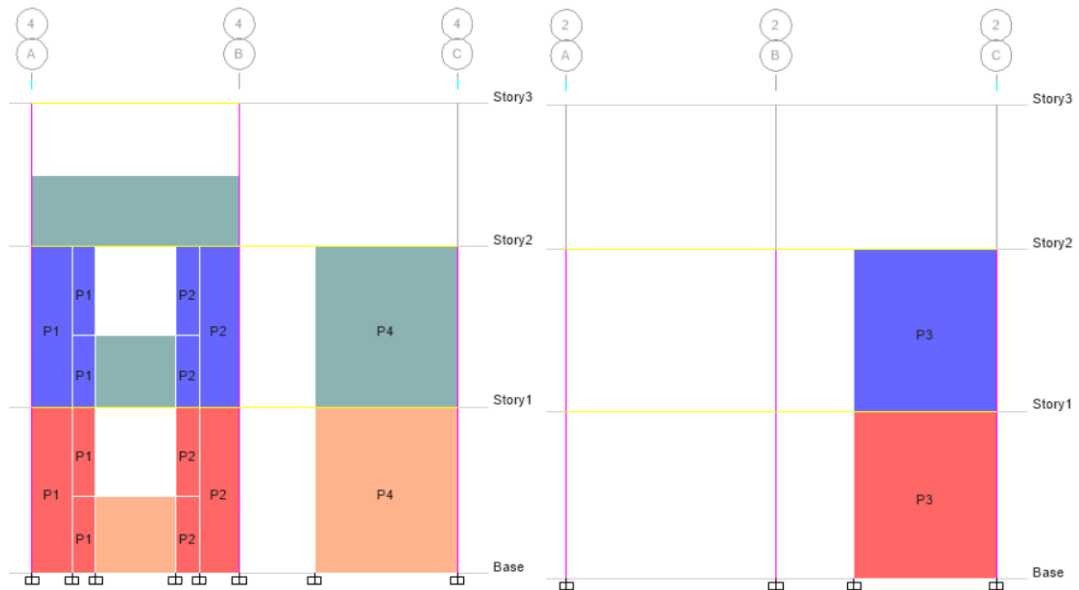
Etiquetado de los muros para los ejes 4-4 y 2-2.
